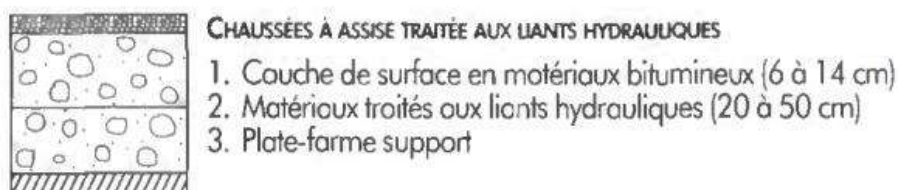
Structure de Chaussées à assise traitée au liant hydraulique
